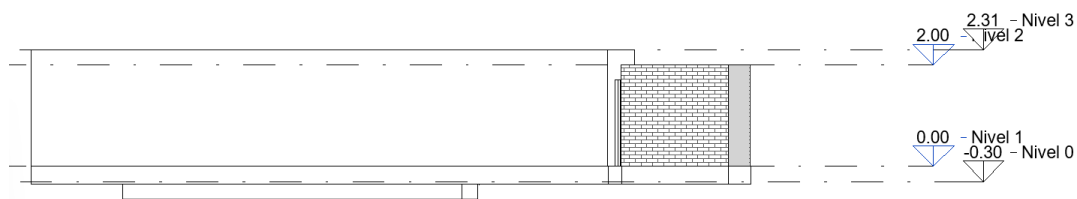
Alzado Norte modelo levantamiento con Cámara 360°. Fuente: elaboración propia.
